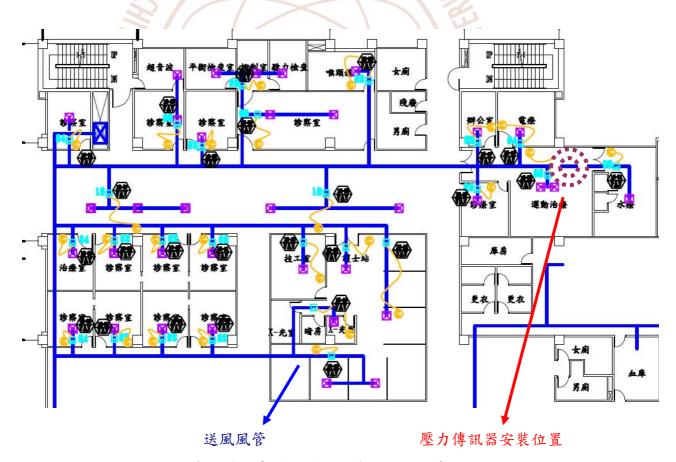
行政院衛生署竹東醫院醫療大樓空調箱風管配置平面圖
